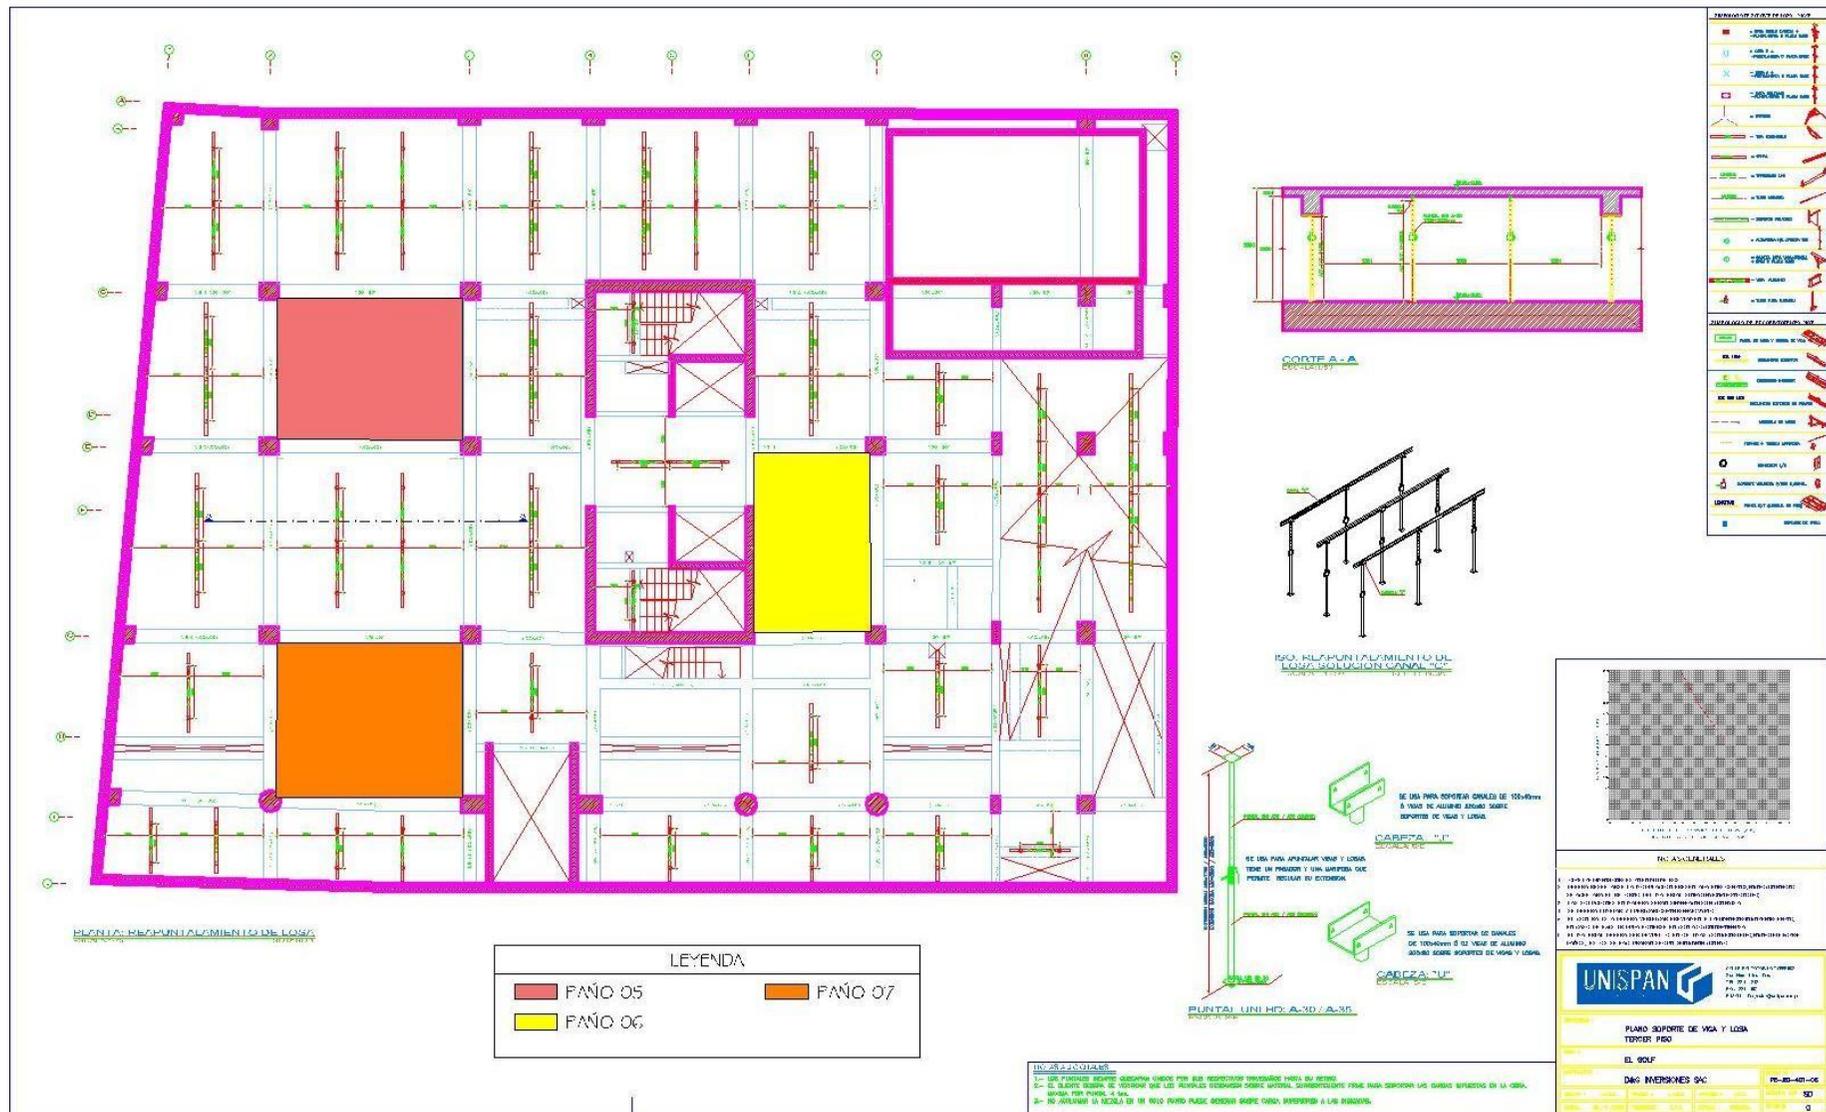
Plano de encofrado metálico de techo 3° Nivel de la obra "Construcción, edificio oficinas El Golf".
